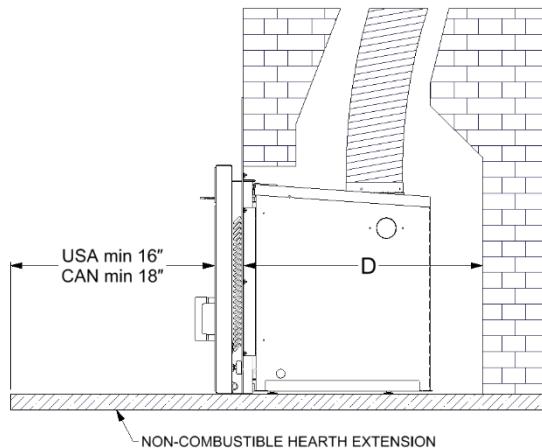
Dimensions minimales de l'ouverture – vue de côté
